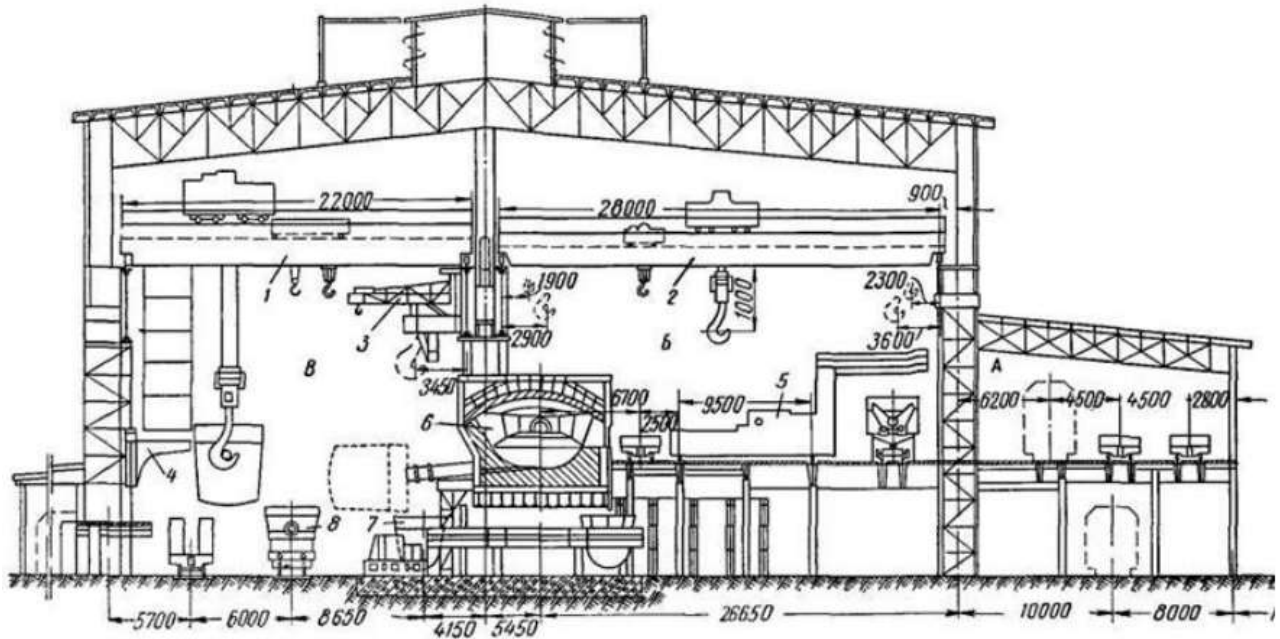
Розріз головної будівлі мартенівського цеху заводу «Запоріжсталь»: А – шихтовий відкрилок; Б – пічний проліт; В – розливний проліт; 1 – розливний кран вантажопідйомністю 320/50/15 т; 2 – заливальний кран вантажопідйомністю 125/30 т; 3 – настінний консольний кран, 7,5 т; 4 – пересувний консольний поворотний кран вантажопідйомністю 1,5 т; 5 – завалочна машина, 7,5 т; 6 – мартенівська піч 500 т; 7 – сталерозливний ківш ємністю 250 т; 8 – шлаковий ківш
